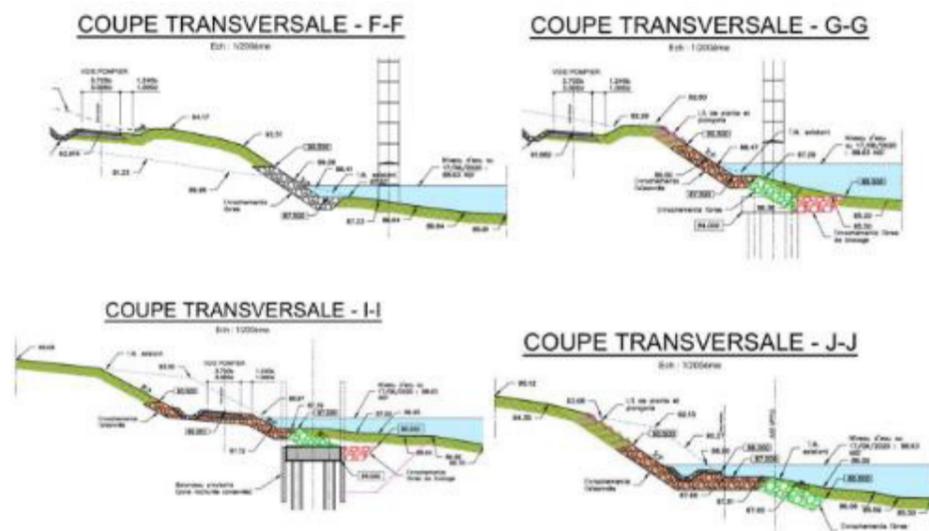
coupes de la protection – rive droite (source : Étude de confortement des berges, Artelia – octobre 2024)
